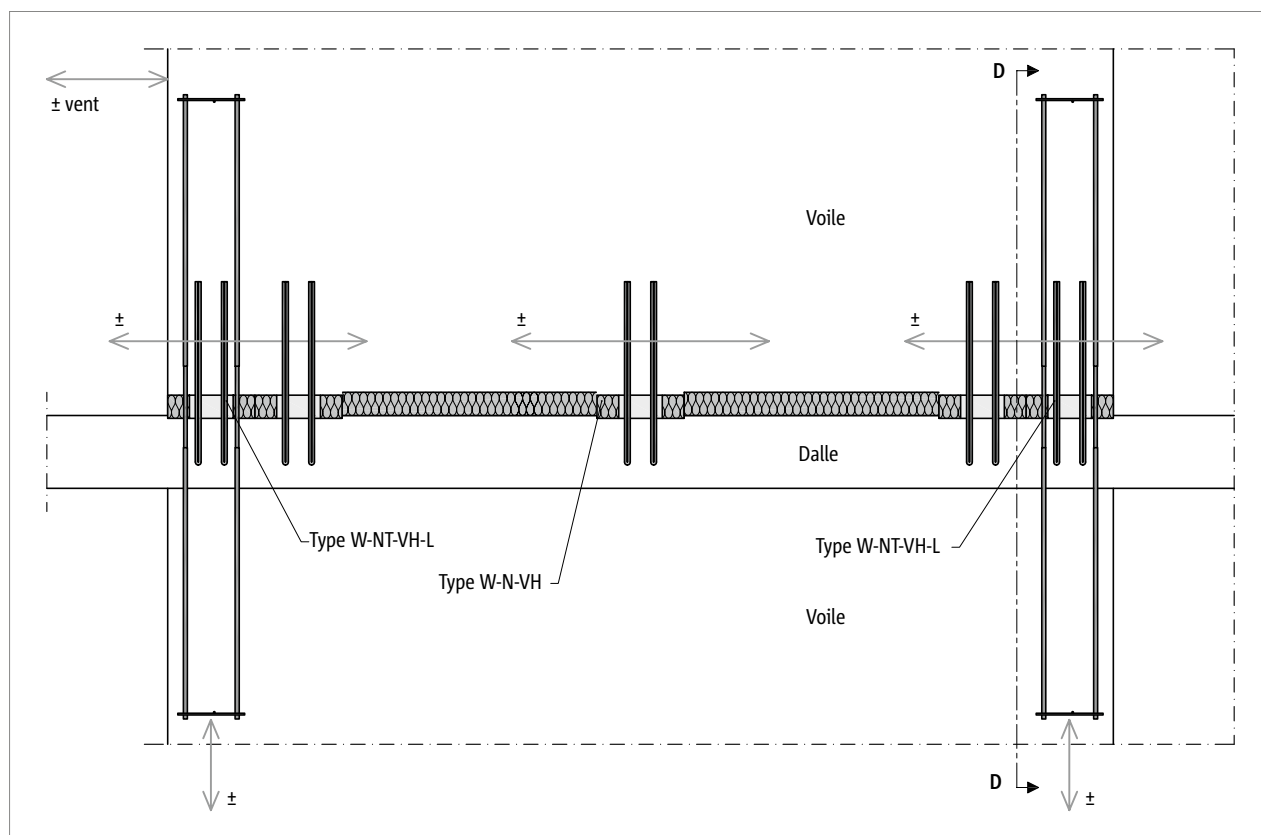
Schöck Sconnex® type W : variantes de produit combinées pour le raccordement d'un mur stabilisant sollicité horizontalement
